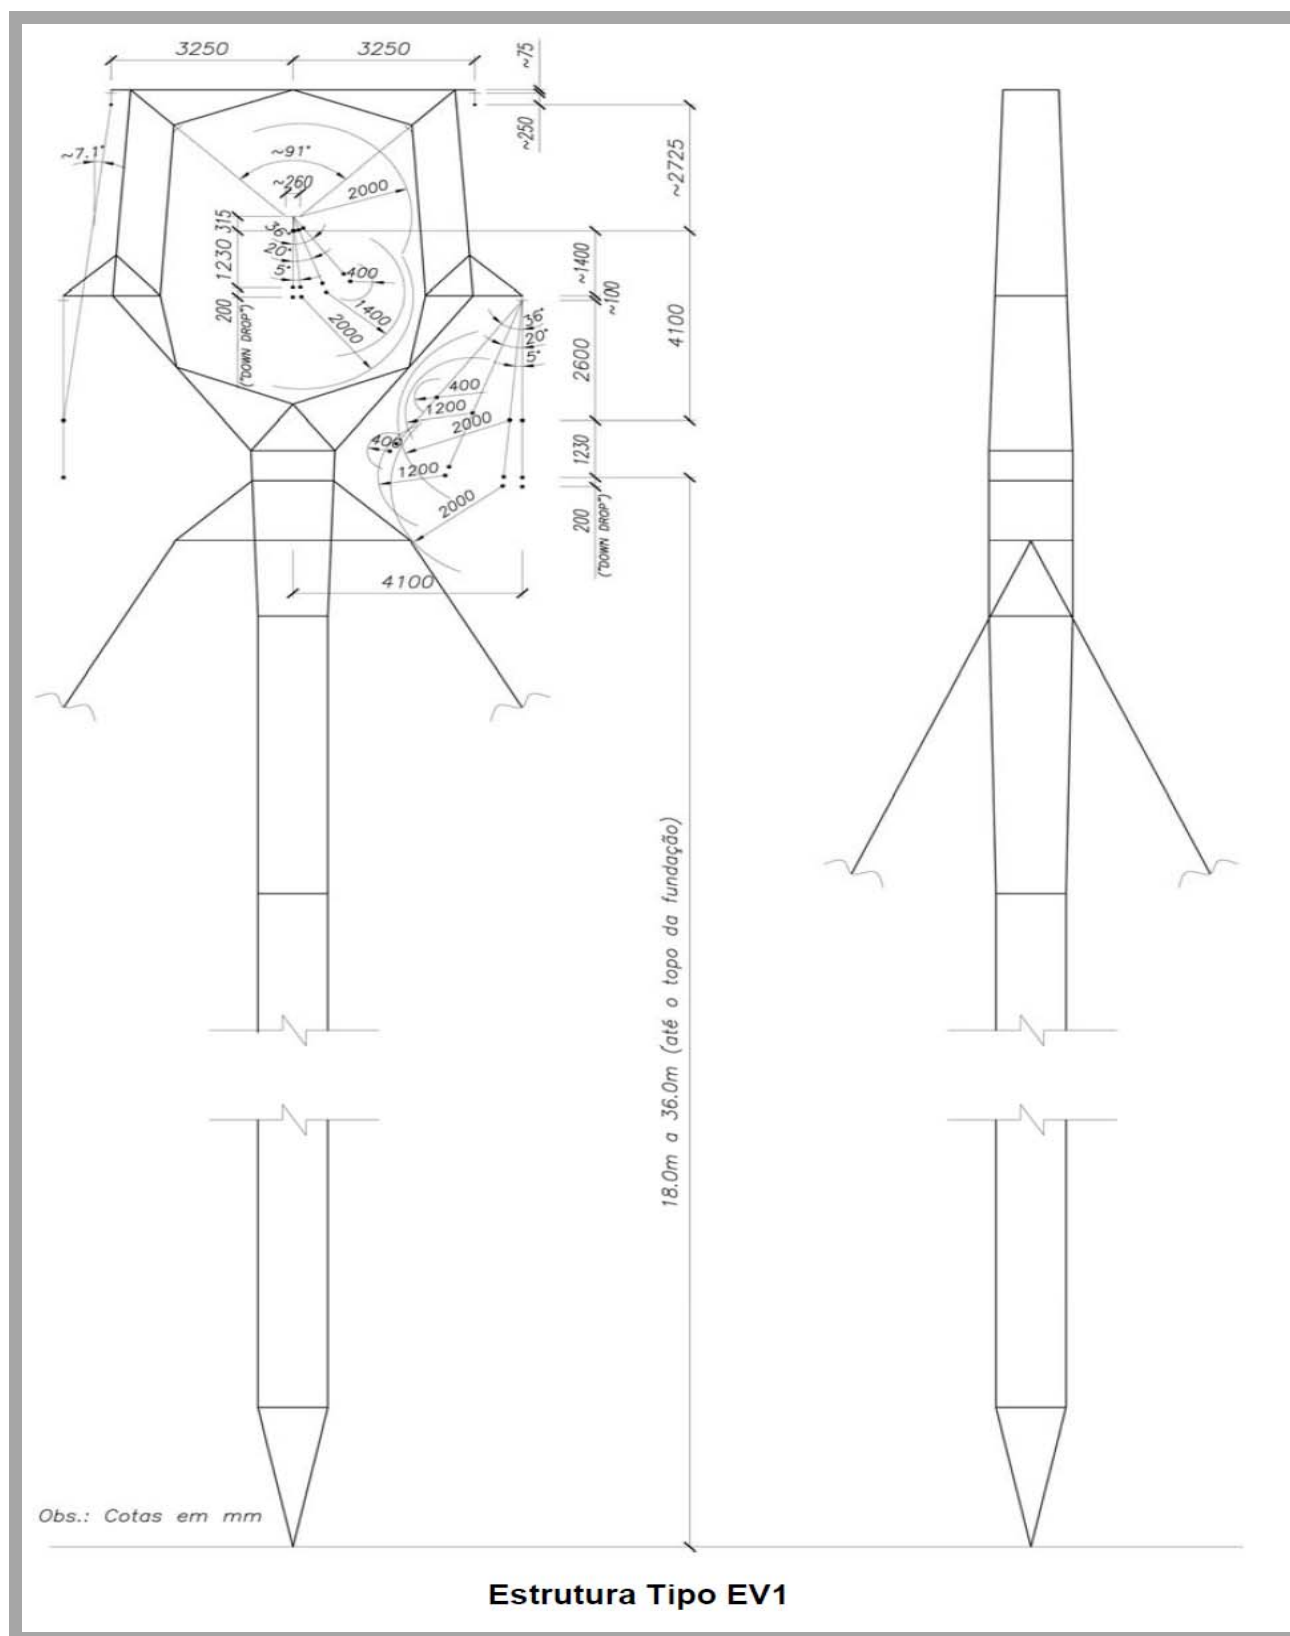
Torre de Suspensão Leve Estaiada.
